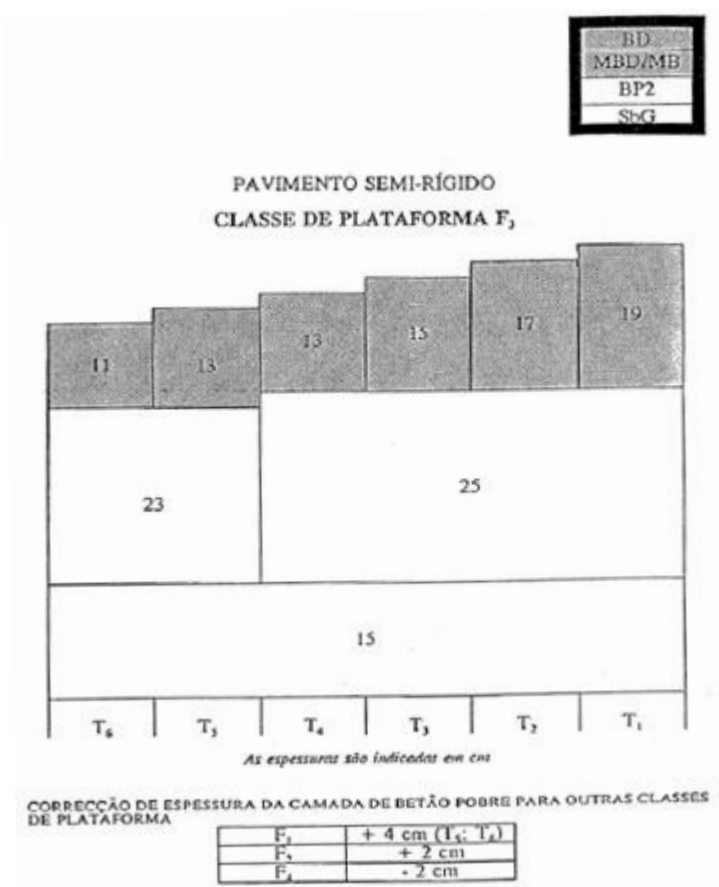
Estrutura de Pavimento Semi-rígido (JAE, 1995).
